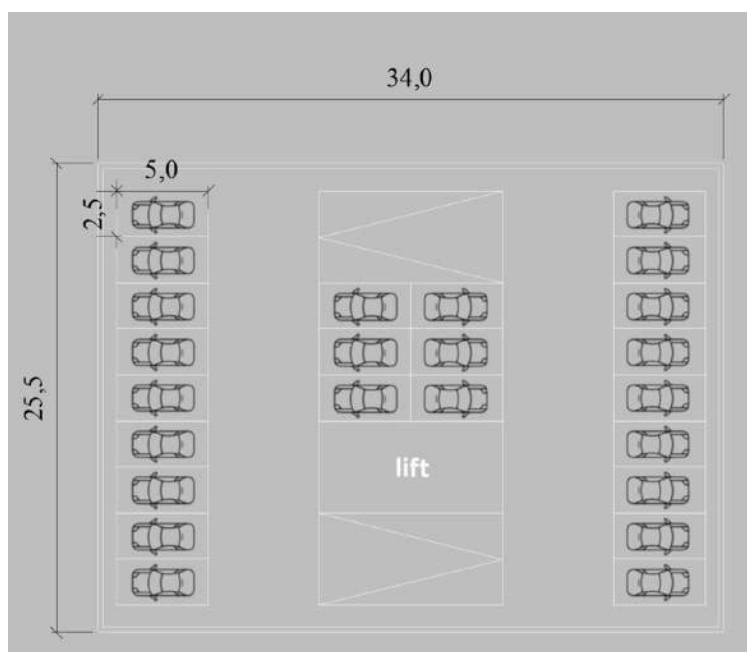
Exemplu plan de parcare supraetajată; Sursa: prelucrare proprie
